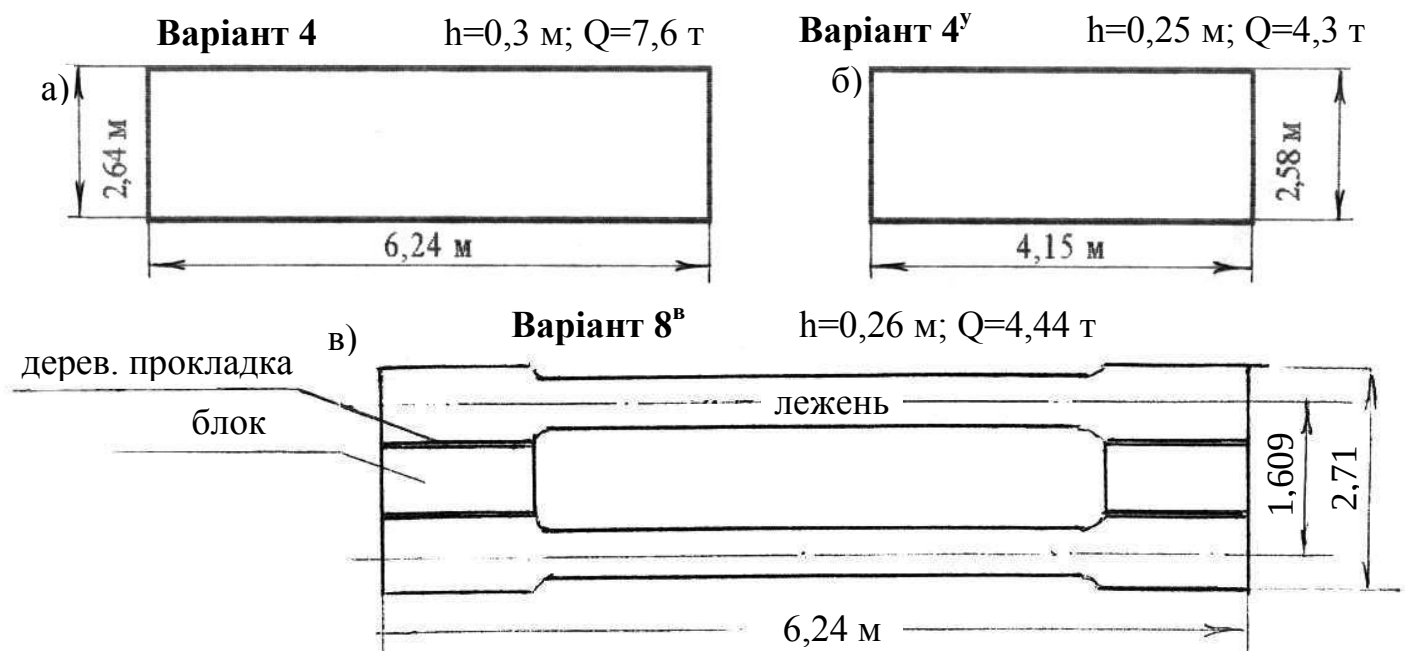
Залізобетонна основа у вигляді залізобетонних плит
